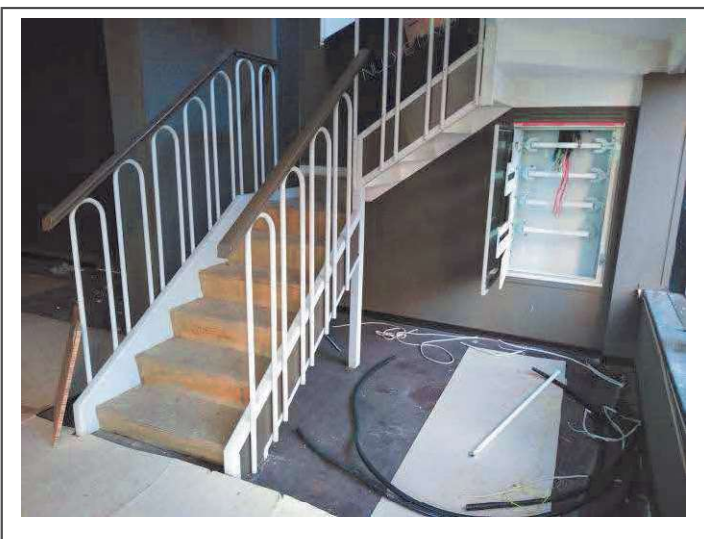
Scala e centralina elettrica vandalizzata
